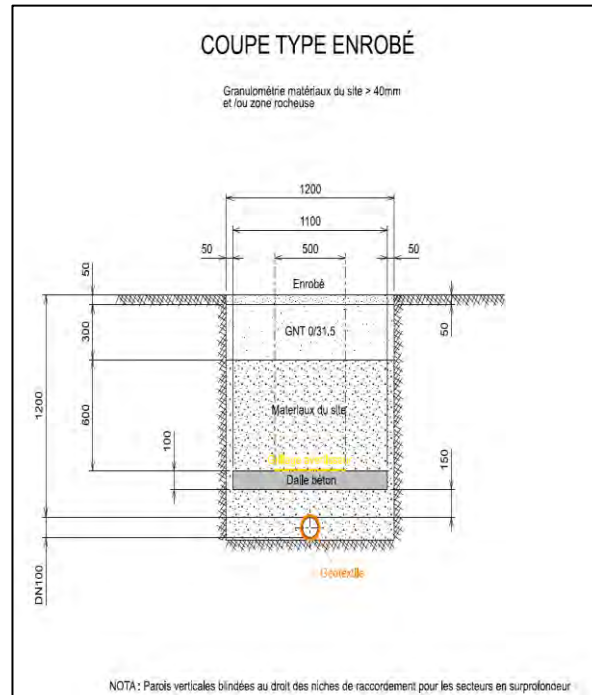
Aperçu du dispositif de sécurité du pipe : dalle en béton, feutre géotextile et protection cathodique.
